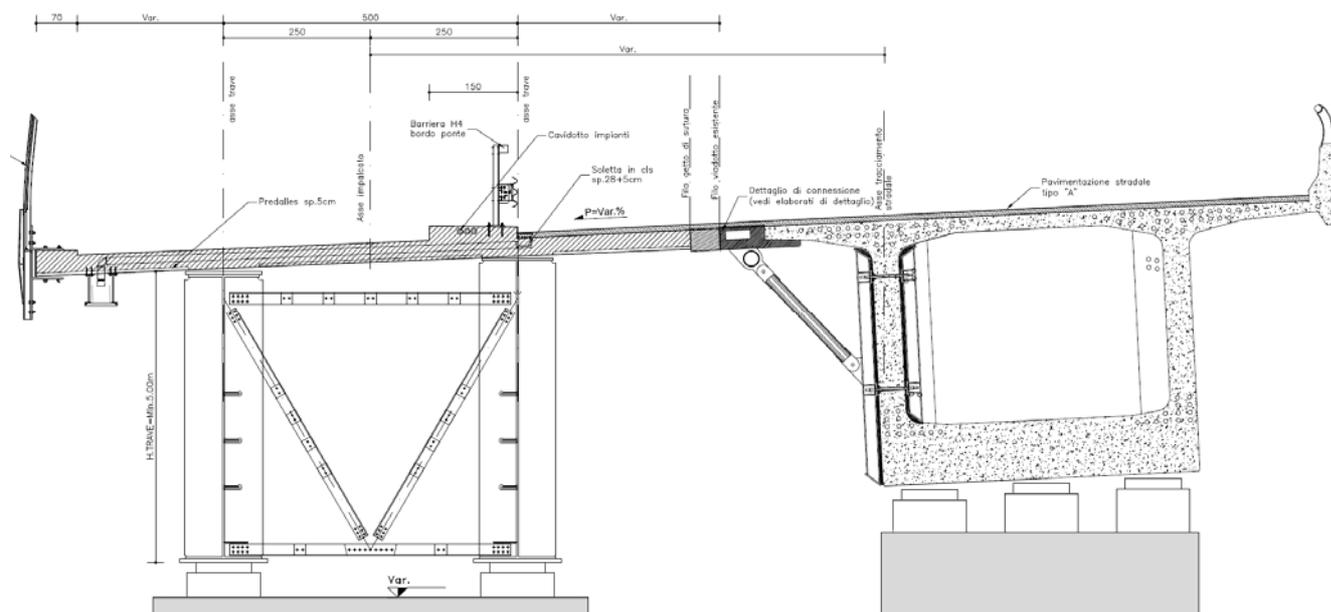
Viadotto Allargamento Salita – tratto solidarizzato – sezione su Pila
